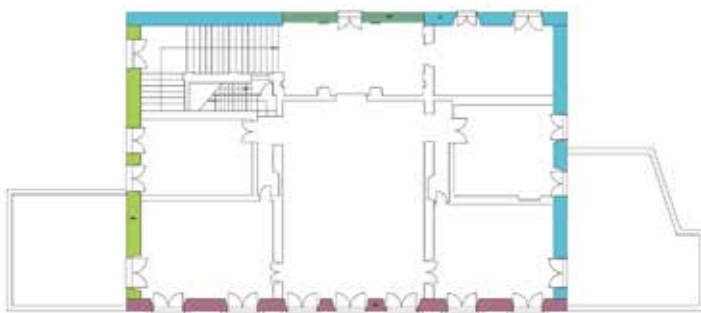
Individuazione dei diversi tipi di muratura dell'involucro opaco al Piano Secondo.
